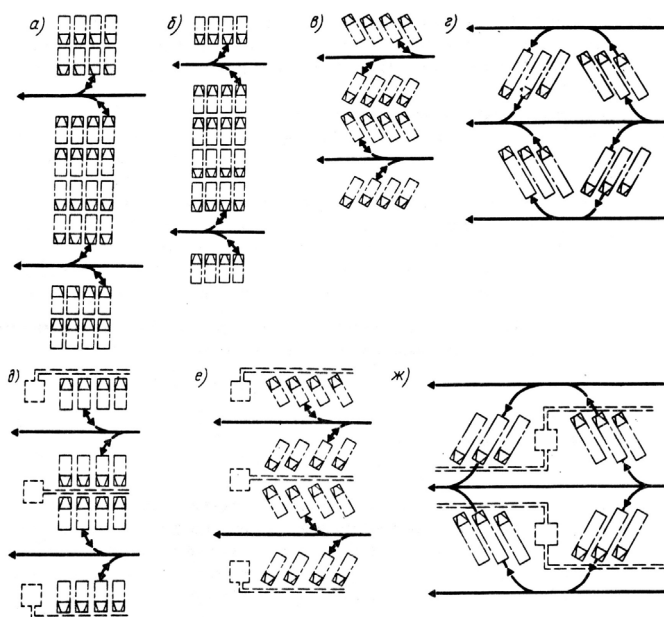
Схема расстановки подвижного состава на открытых площадках хранения
